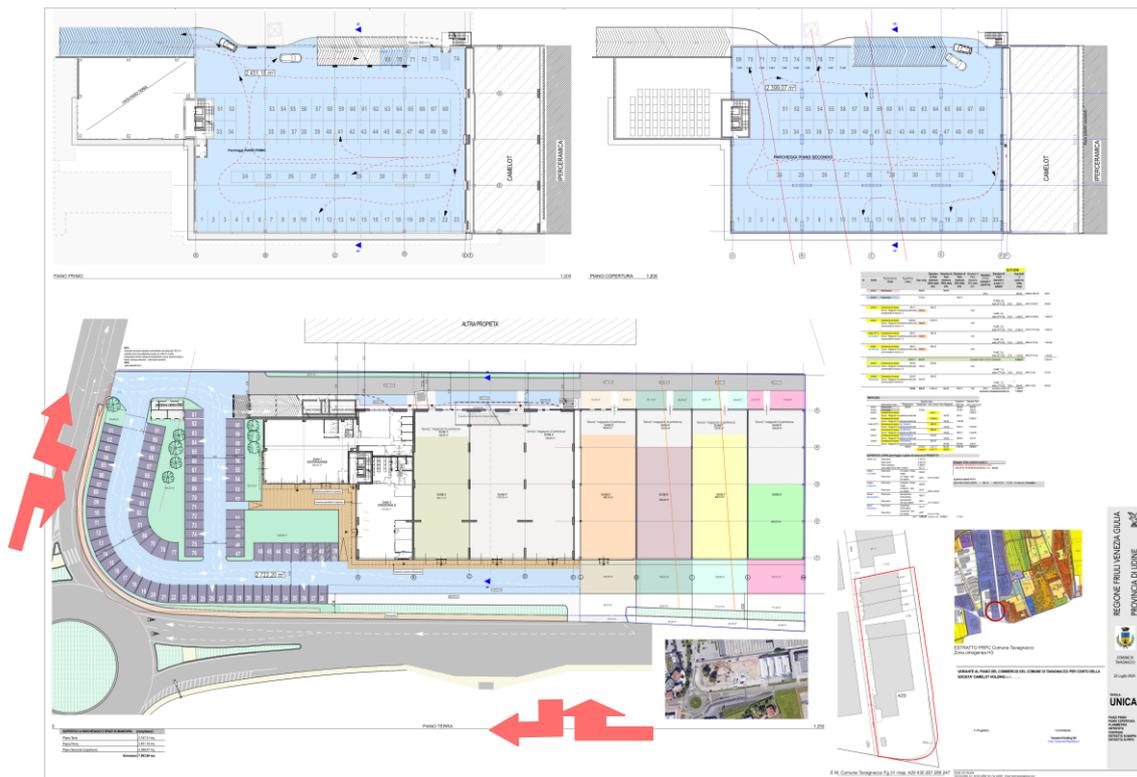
Planimetria del progetto edilizio con l'evidenza dei movimenti consentiti agli accessi
